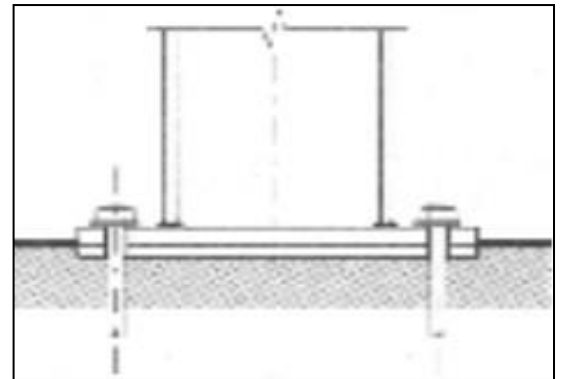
Assemblages poteaux poutre source : [beton/https://www.toutsurlebeton.fr/mise-en-oeuvre/le-radier-de-fondation-en-beton/](https://www.toutsurlebeton.fr/mise-en-oeuvre/le-radier-de-fondation-en-beton/)
